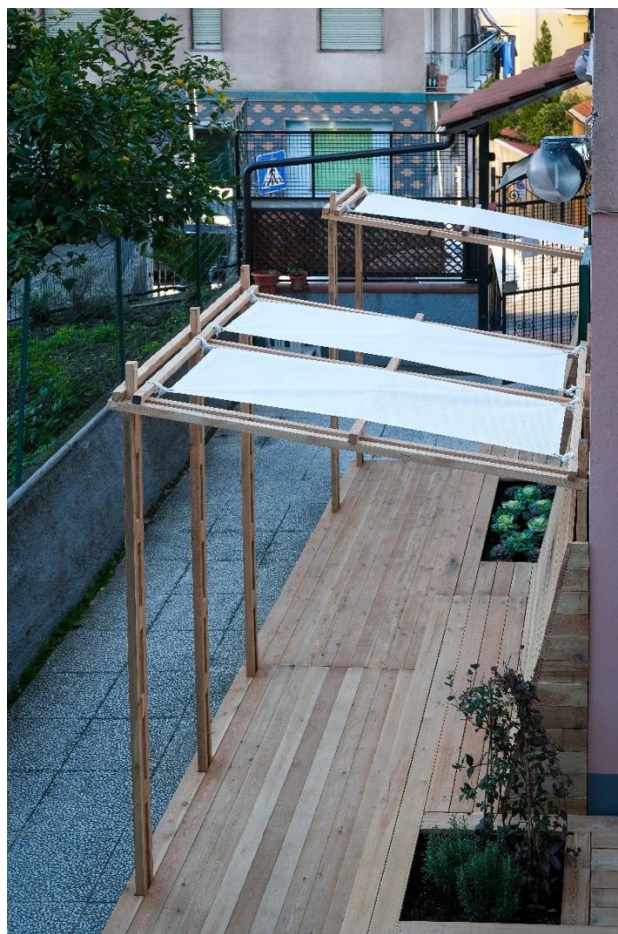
La struttura esterna al termine del workshop di autocostituzione; vista delle strutture per l'ombreggiamento delle sedute.
